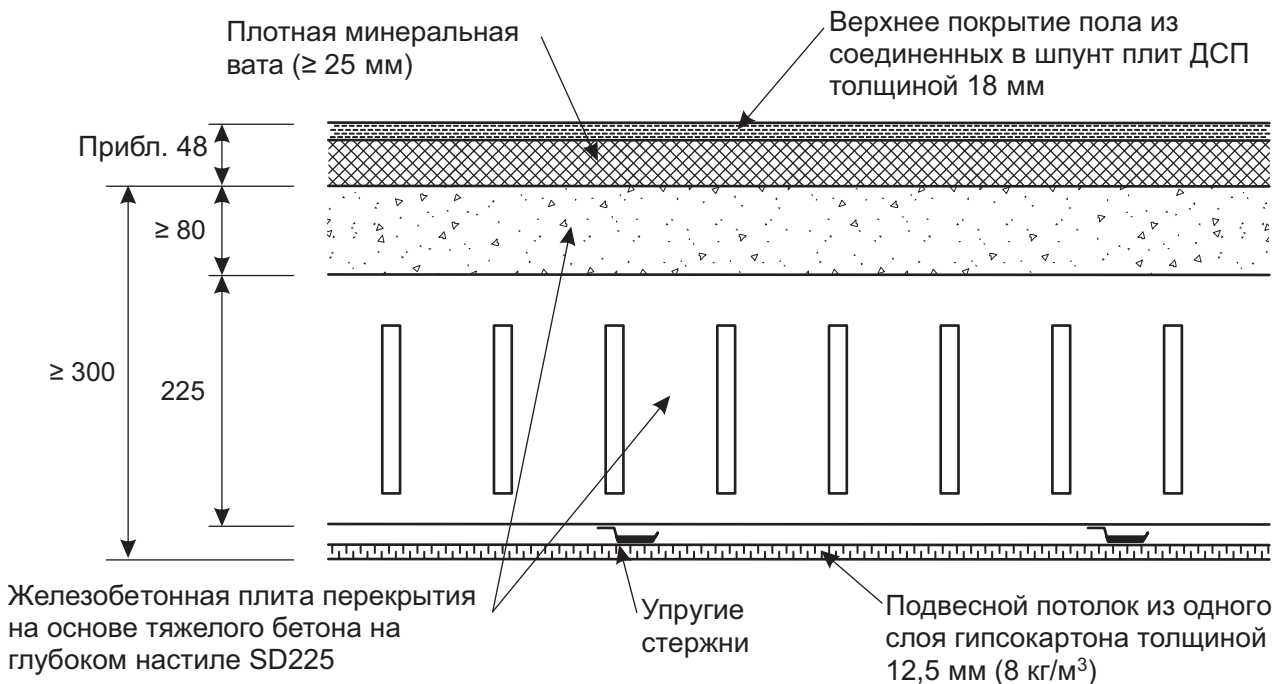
Комбинированная плита перекрытия на глубоком настиле и многослойным упругим покрытием (классифицируется как надежная конструкция)
